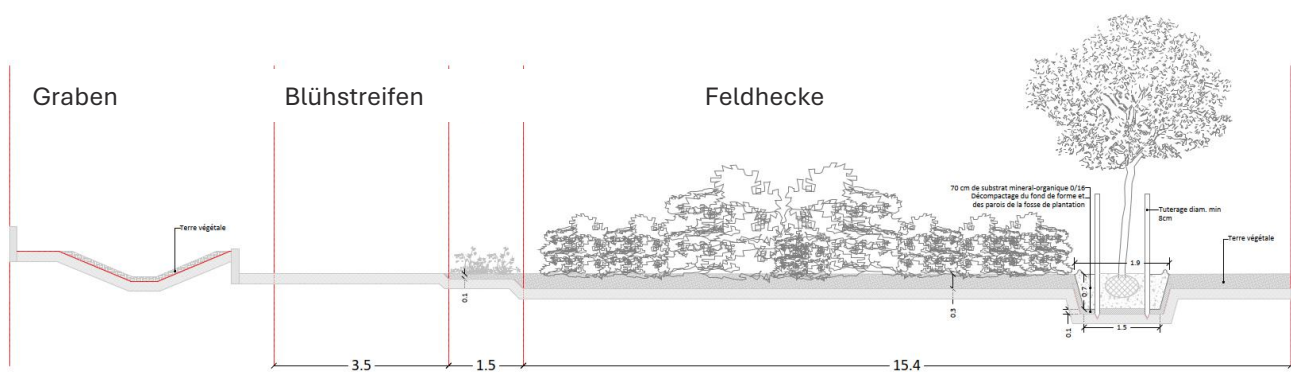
Detail F-F des Plan de Plantation, nordöstliche Eingrünung (Quelle: Papaya Sàrl 2025). Größere Darstellung in Anhang 06a.
